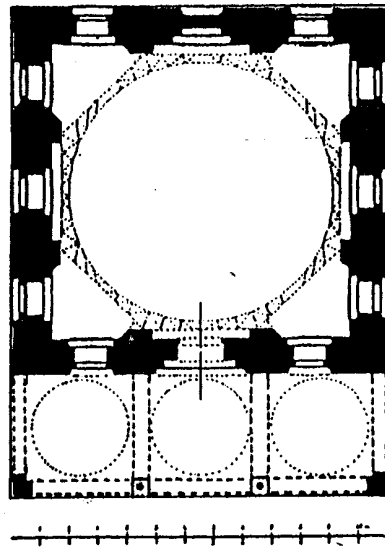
مسقط أفقي لجامع احمد باشا في انقرة (عن : Kuran)
